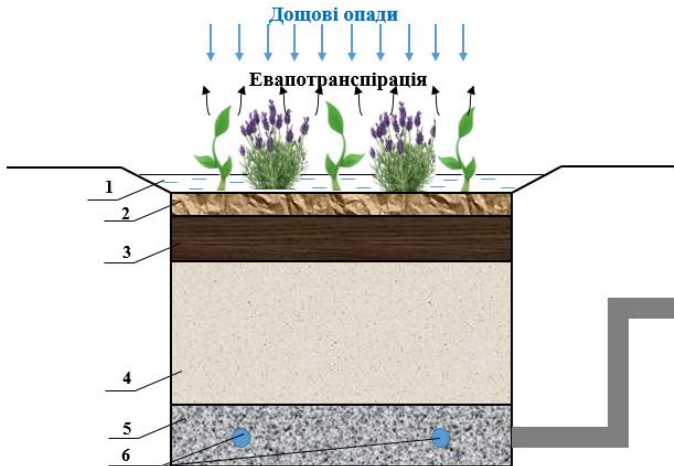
Основні елементи конструкції дощового саду в перерізі (авторська розробка): 1 – шар для утворення стовпа води; 2 – шар ґрунтопокривних матеріалів; 3 – шар ґрунтової суміші для висадки рослин; 4 – інфільтраційний/проміжний шар; 5 – шар гравію; 6 – дренажна система
